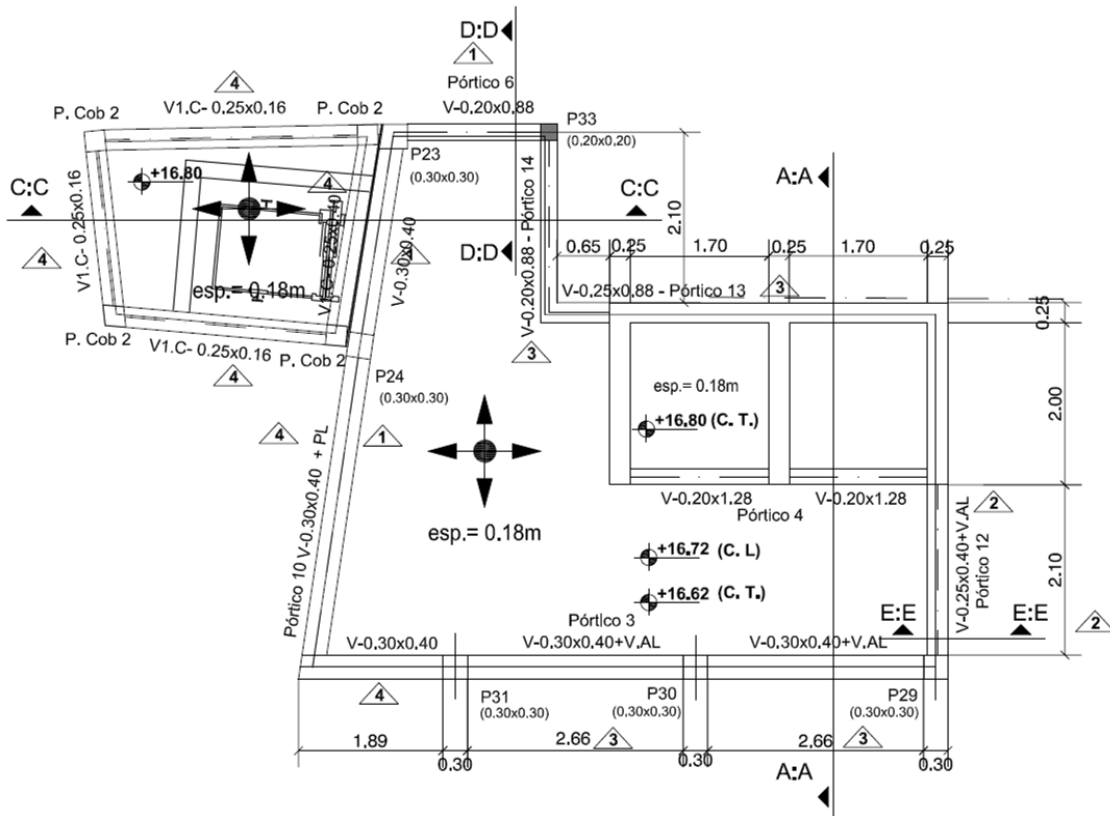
Planta da cobertura - preparação dos trabalhos [AVicêncio A, 2017]
